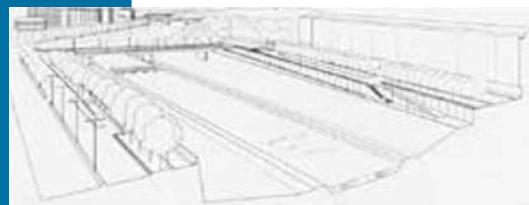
La sezione dell'invaso fluviale secondo lo schema individuato dal progetto.
